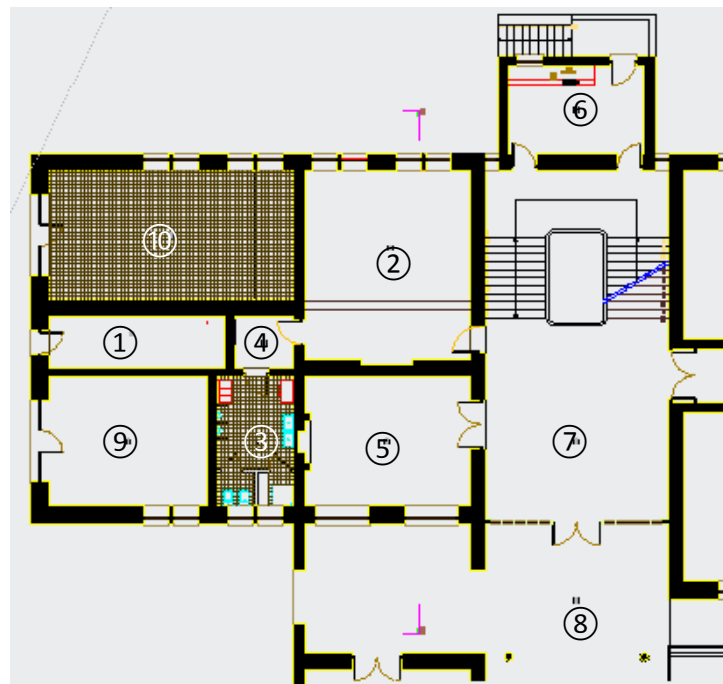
Planta existente da zona onde se pretende fazer a cozinha (Planta da autoria do Arq. Hugo Espanhol)
